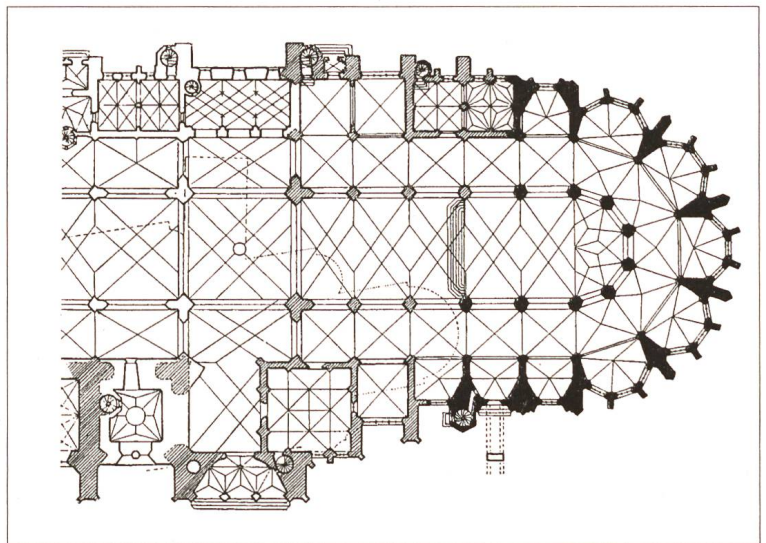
Chorgrundriss des Veitsdoms in Prag.
